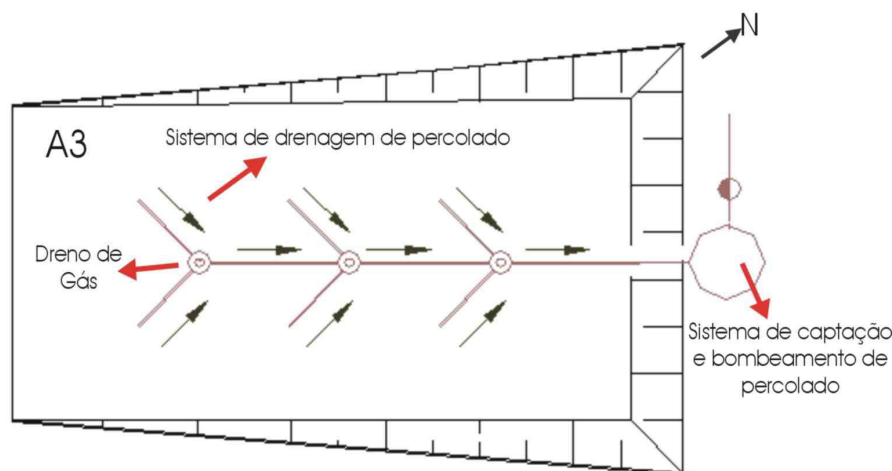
Esquema da planta baixa do projeto de remediação da área A3.
